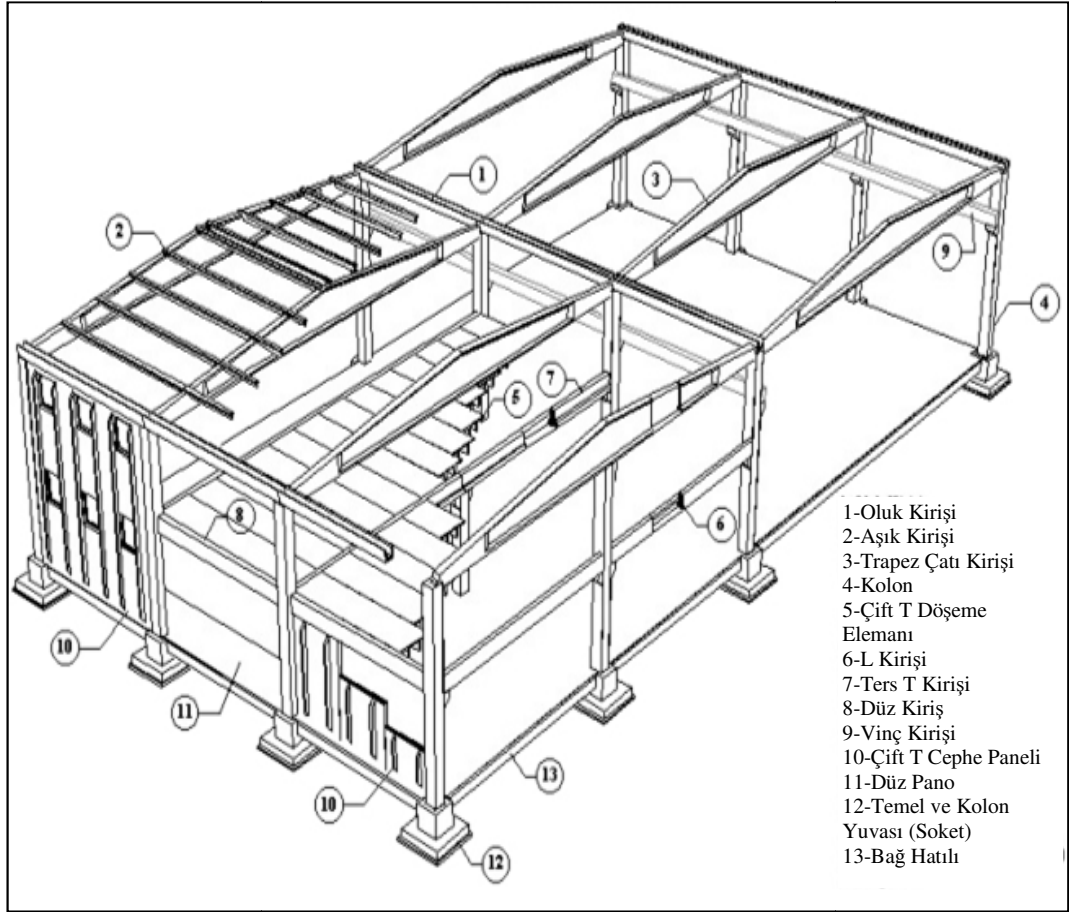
Prefabrik sanayi yapısının önden görünüşü [5].
